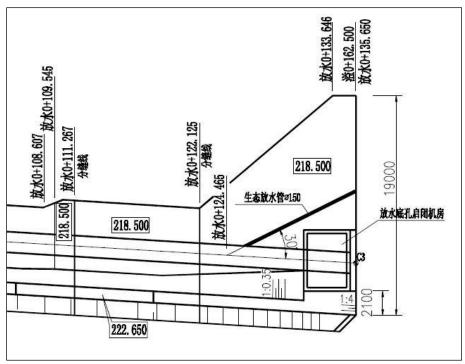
放水底孔尾部平面布置图 (生态放水管布置图)
